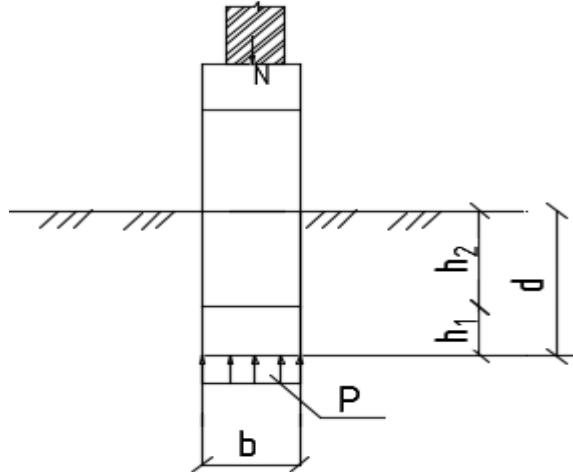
Нагрузка, действующая на ленточный фундамент
